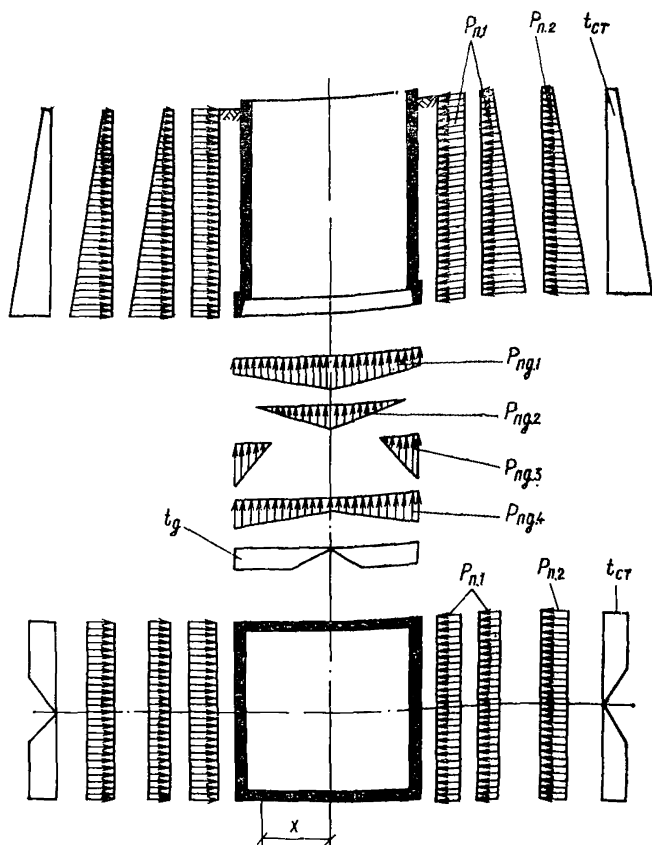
Схемы прямоугольного колодца с расчетными дополнительными нагрузками, вызванными подработкой основания
